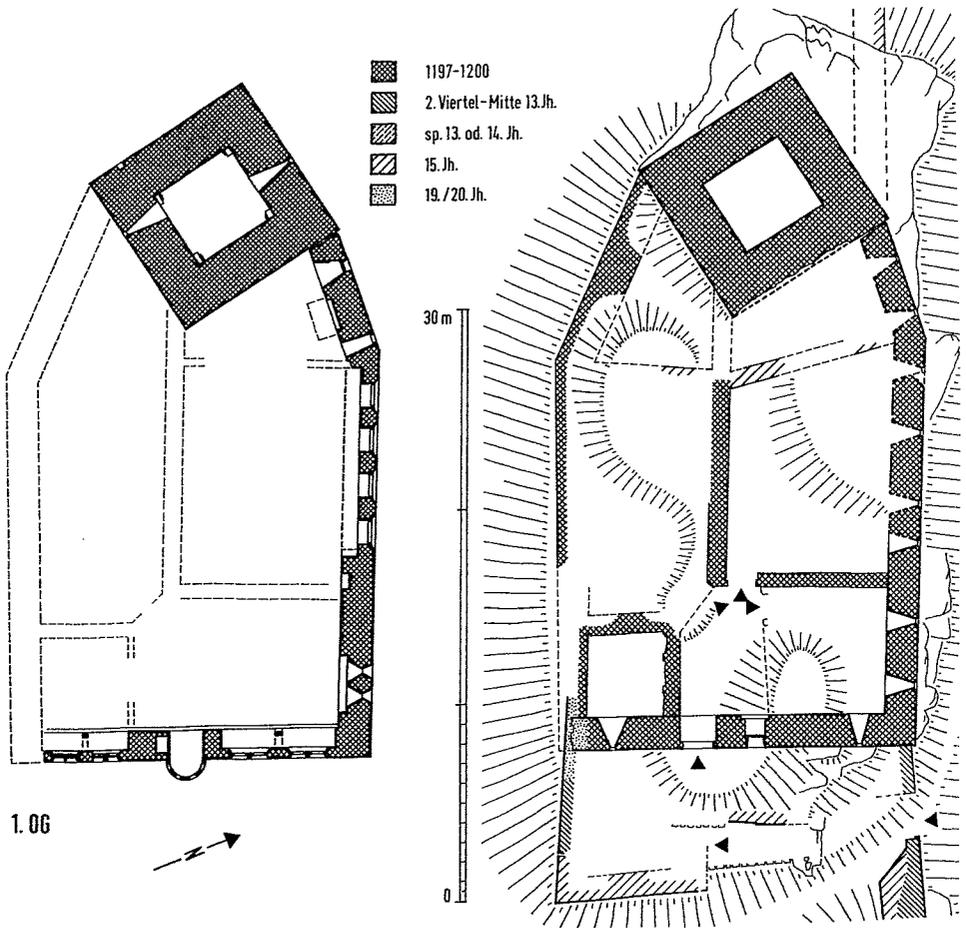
Landsberg am Odilienberg, Baualterplan der Kernburg, Erdgeschoß (rechts) und 1. Obergeschoß (Biller auf Grundlage einer Bauaufnahme der TU Berlin, 1987)
